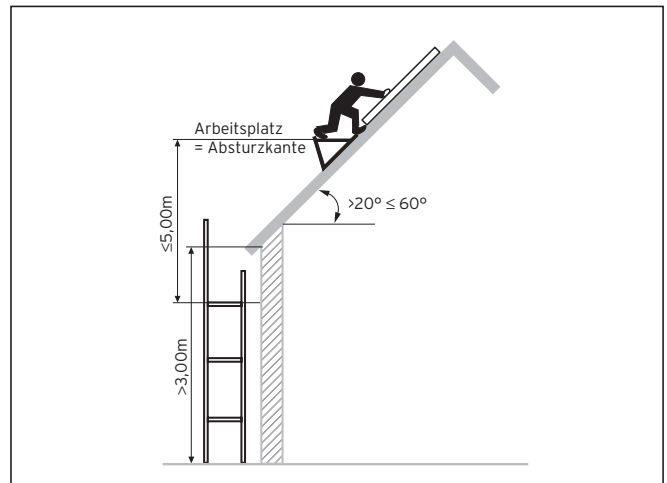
Dachfanggerüste für Arbeiten auf geneigten Dachflächen
